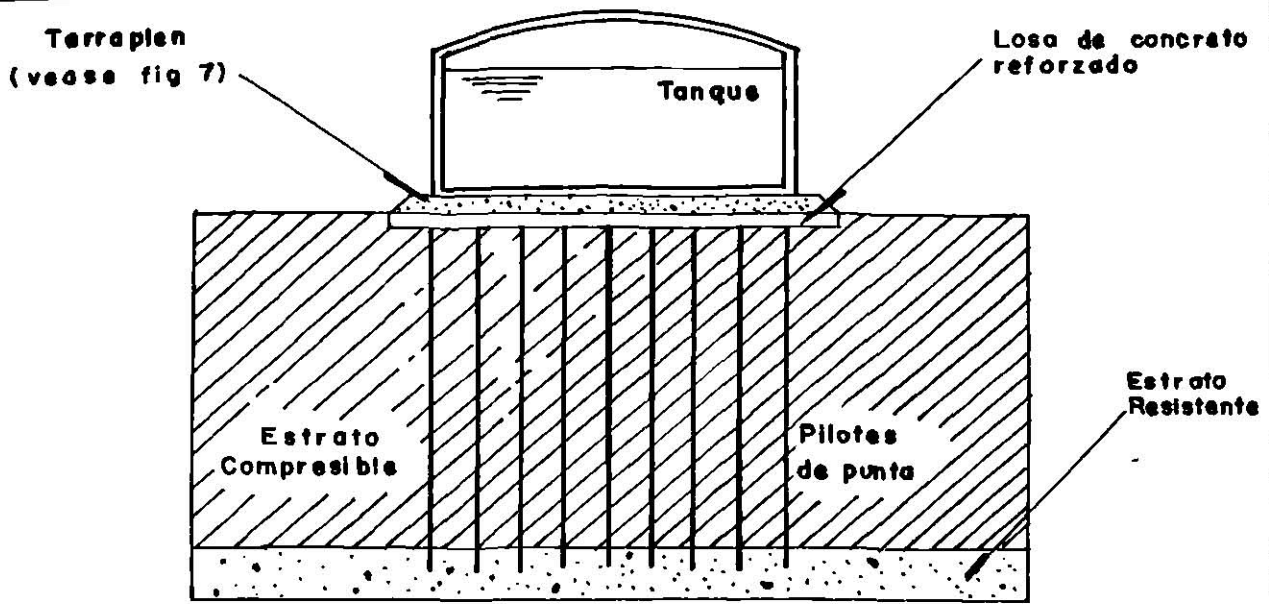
CIMENTACION RIGIDA SOBRE PILOTES DE PUNTA
